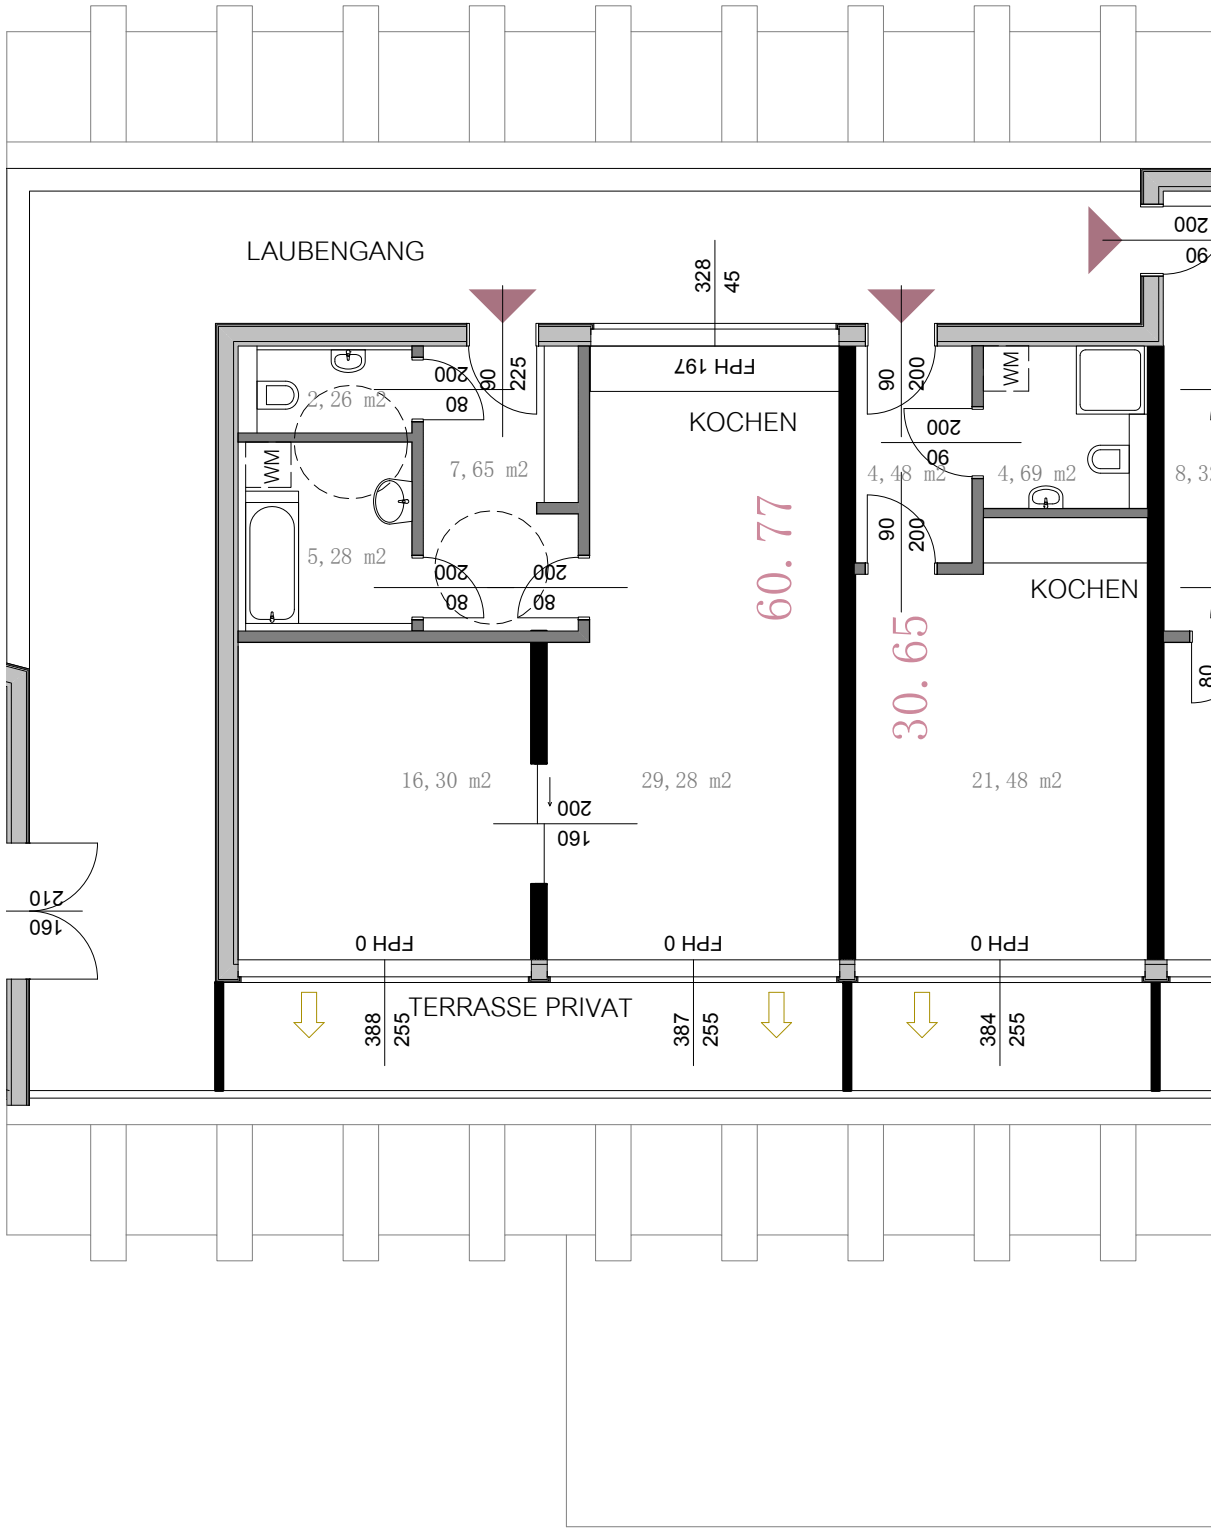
Ausschnitt Grundriss 2. Obergeschoss
